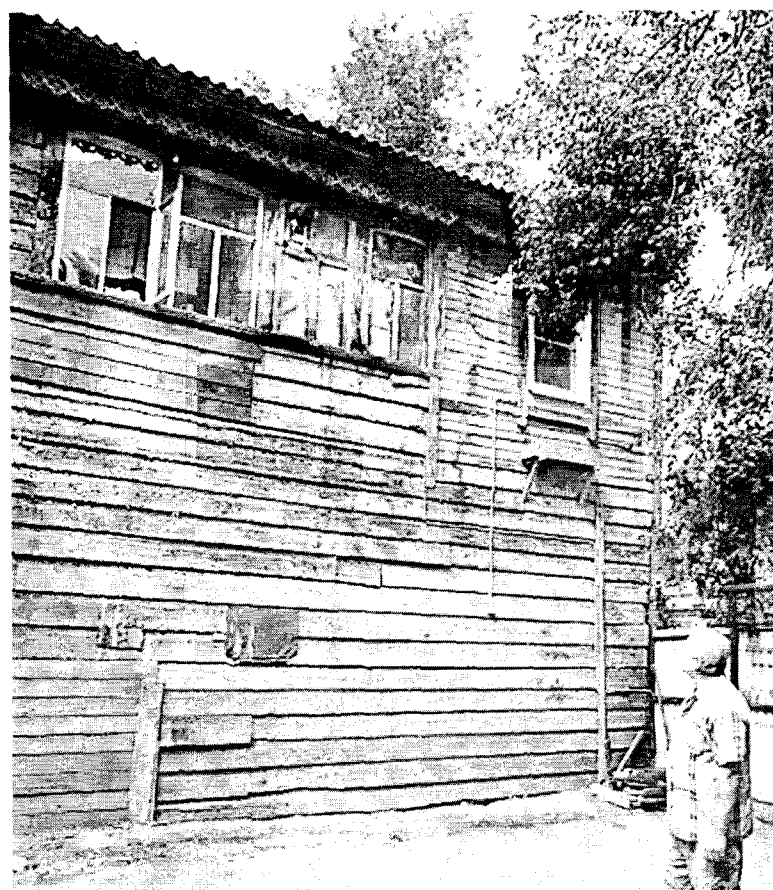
Фрагмент продольного, дворового (северо-восточного) фасада прируба сений с лестницей на 2-ой этаж
